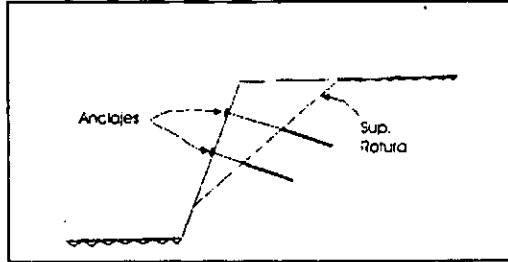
Anclajes para estabilizar la falla por deslizamiento plano.
